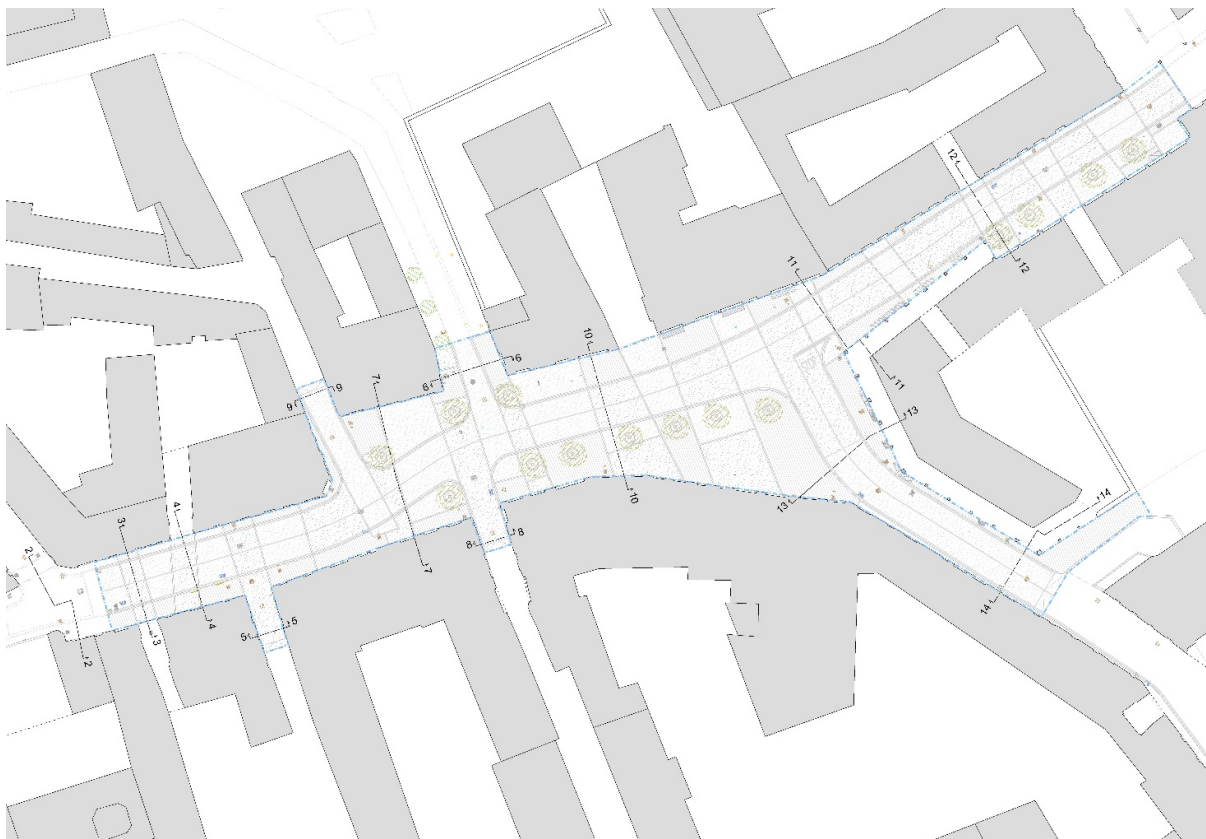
Planimetria stato di progetto – Fonte: Elaborazione Piani e progetti architetti, Milano
